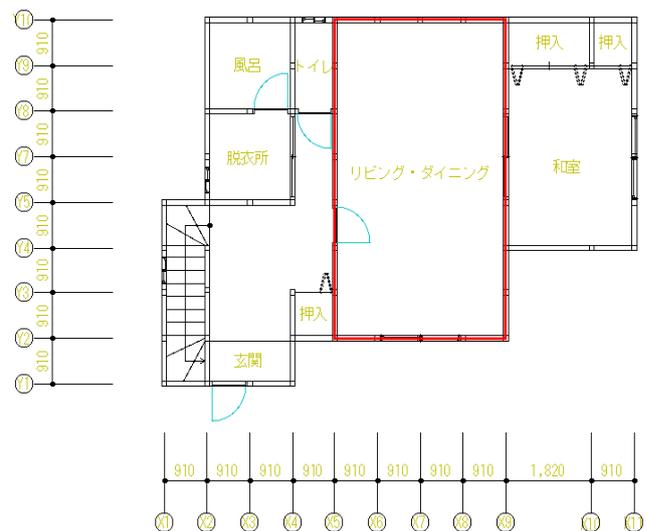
生活基盤ユニット補強施工箇所を示した対象建築物1階平面図
